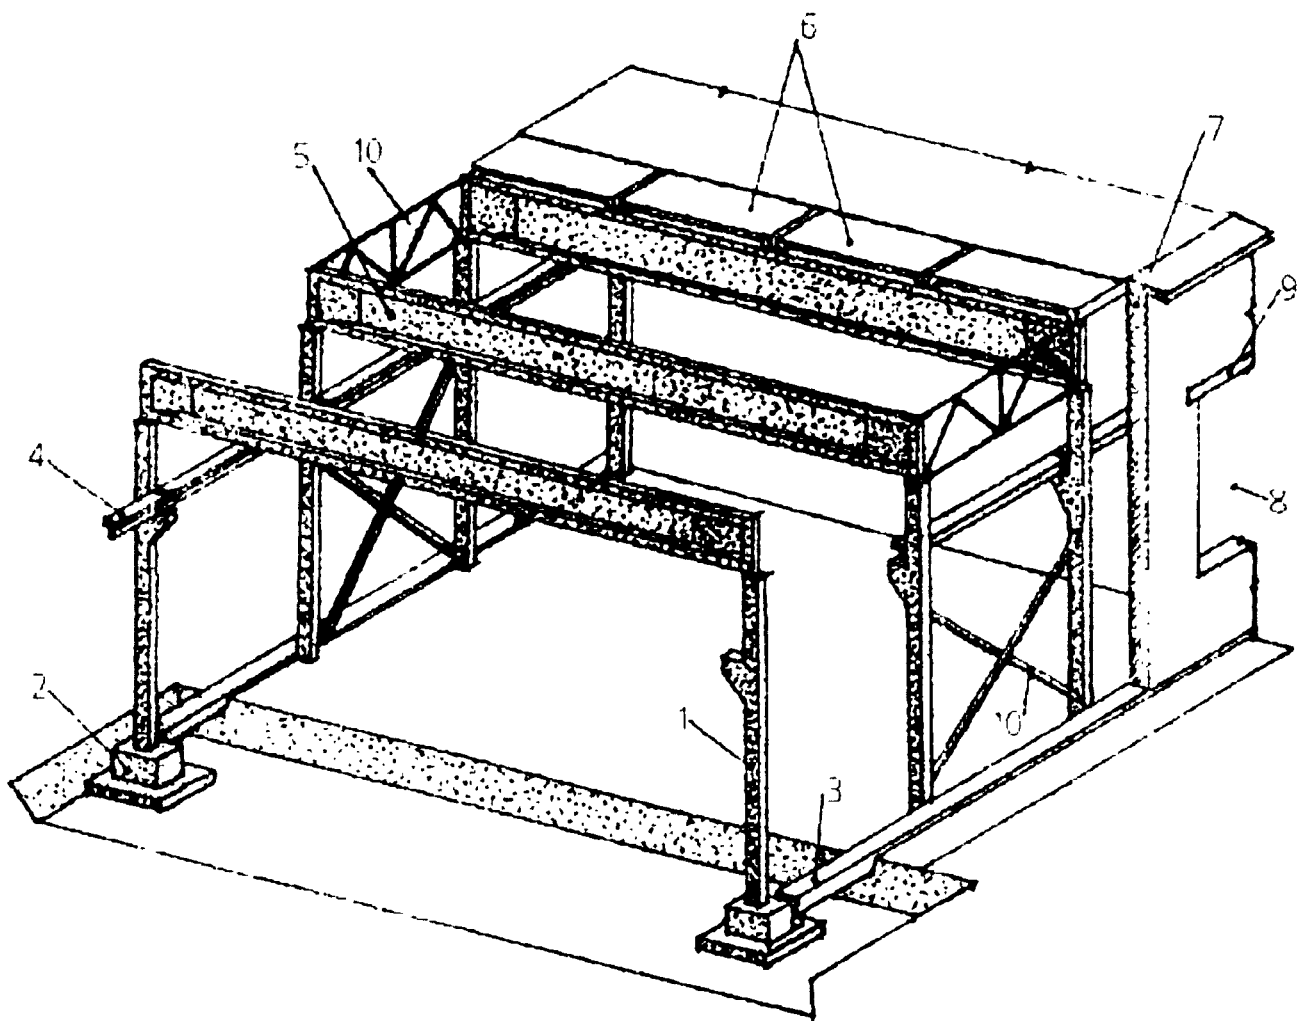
Одноэтажный железобетонный каркас промышленного здания: 1 - колонна; 2 - столбчатый фундамент; 3 - фундаментная балка; 4 - подкрановая балка; 5 - стропильная балка; 6 - плита покрытия; 7 - наружная стена; 8 - окно; 9 - перемычка; 10 - связи
